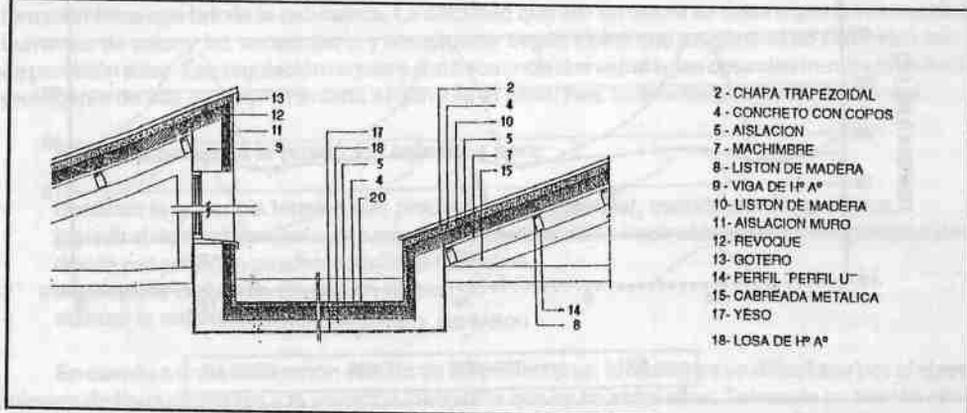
CORTE TRANSVERSAL DE CUBIERTA
